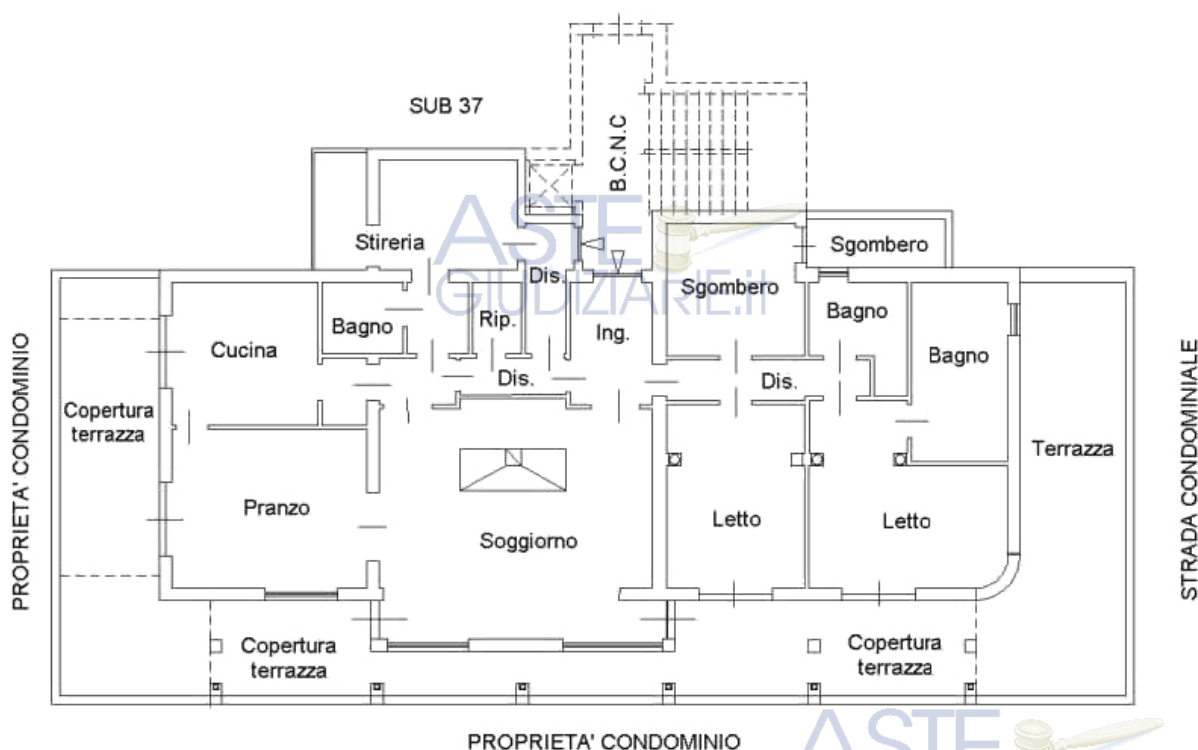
Planimetria catastale 2017 - Pianta piano settimo
